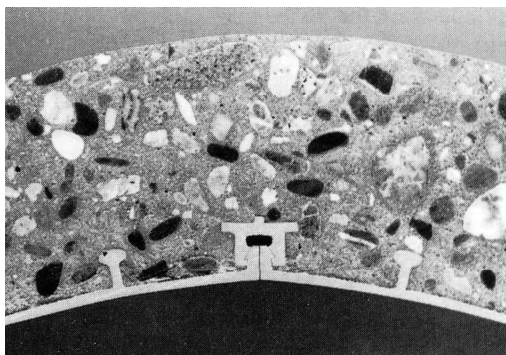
Разрез бетонной трубы с отделкой из жестких ПВХ поперечных ребер (система VKU).
